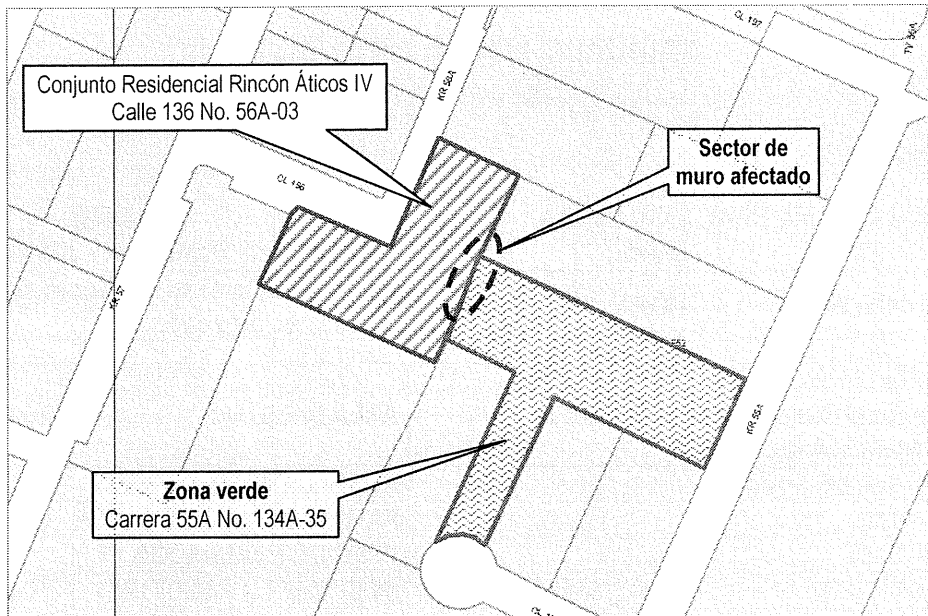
Localización del muro del costado oriental del predio de la Calle 136 No. 56A-03, afectado por agrietamiento.
